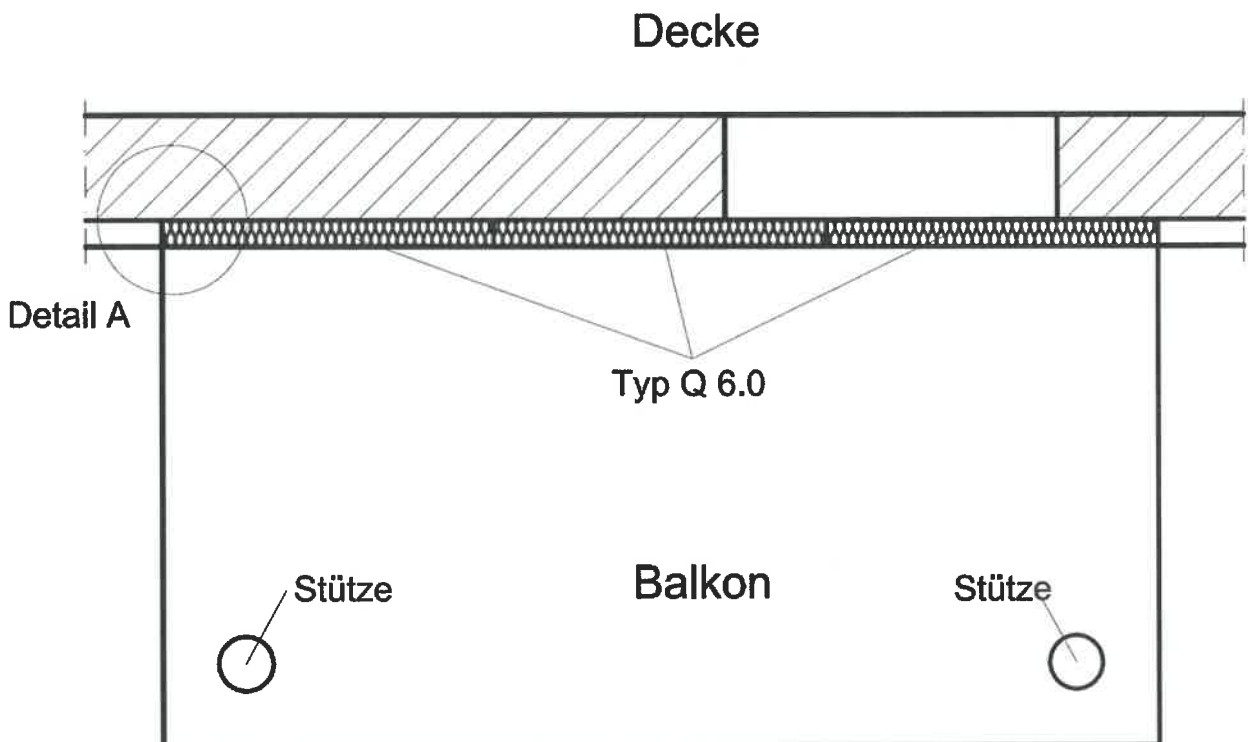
Einbausituation Schöck Isokorb® T Typ Q 6.0 - Grundriss
